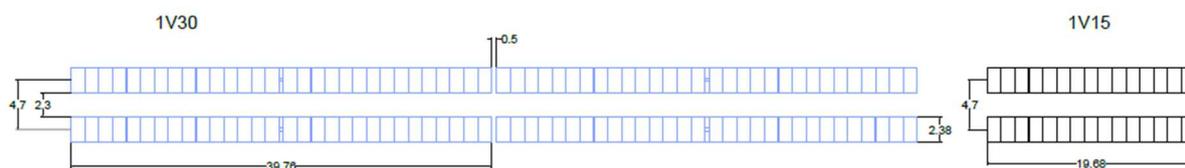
Vista in pianta di quattro tracker (quote espresse in metri)
